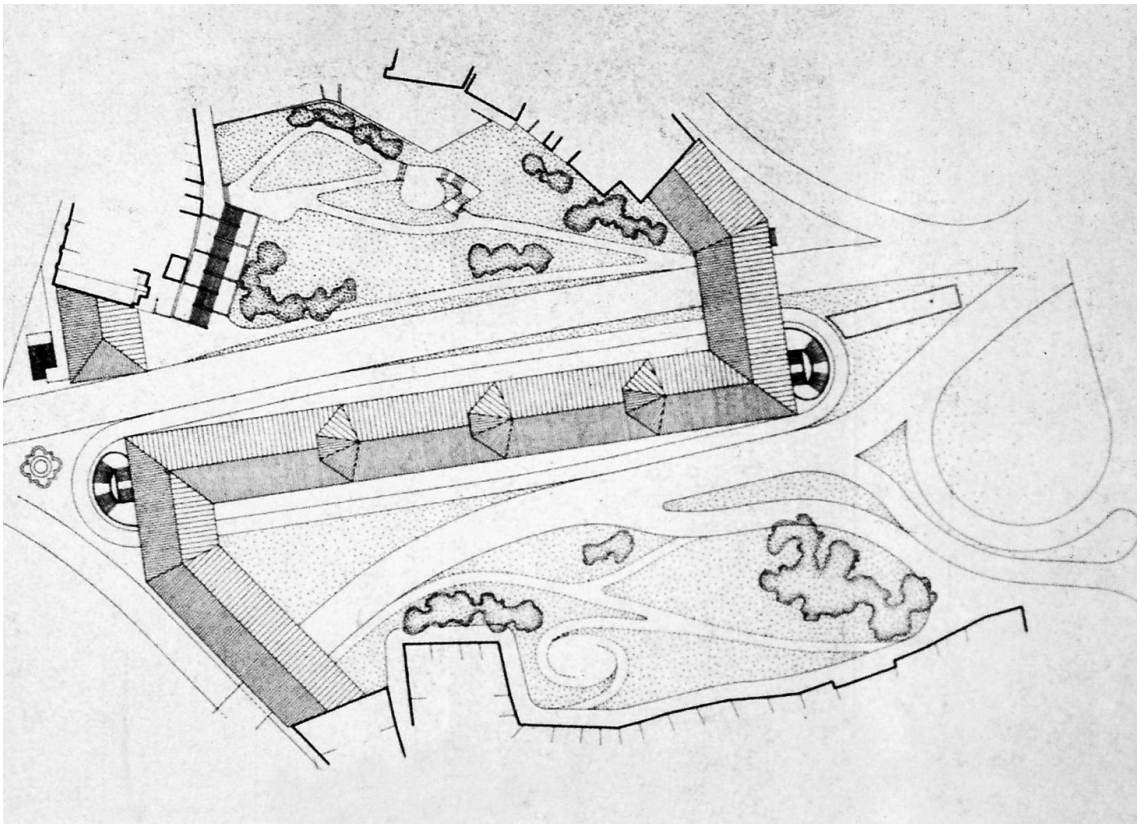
Luís Cunha, Proposta geral para Avenida da Ponte, Planta, 1959
